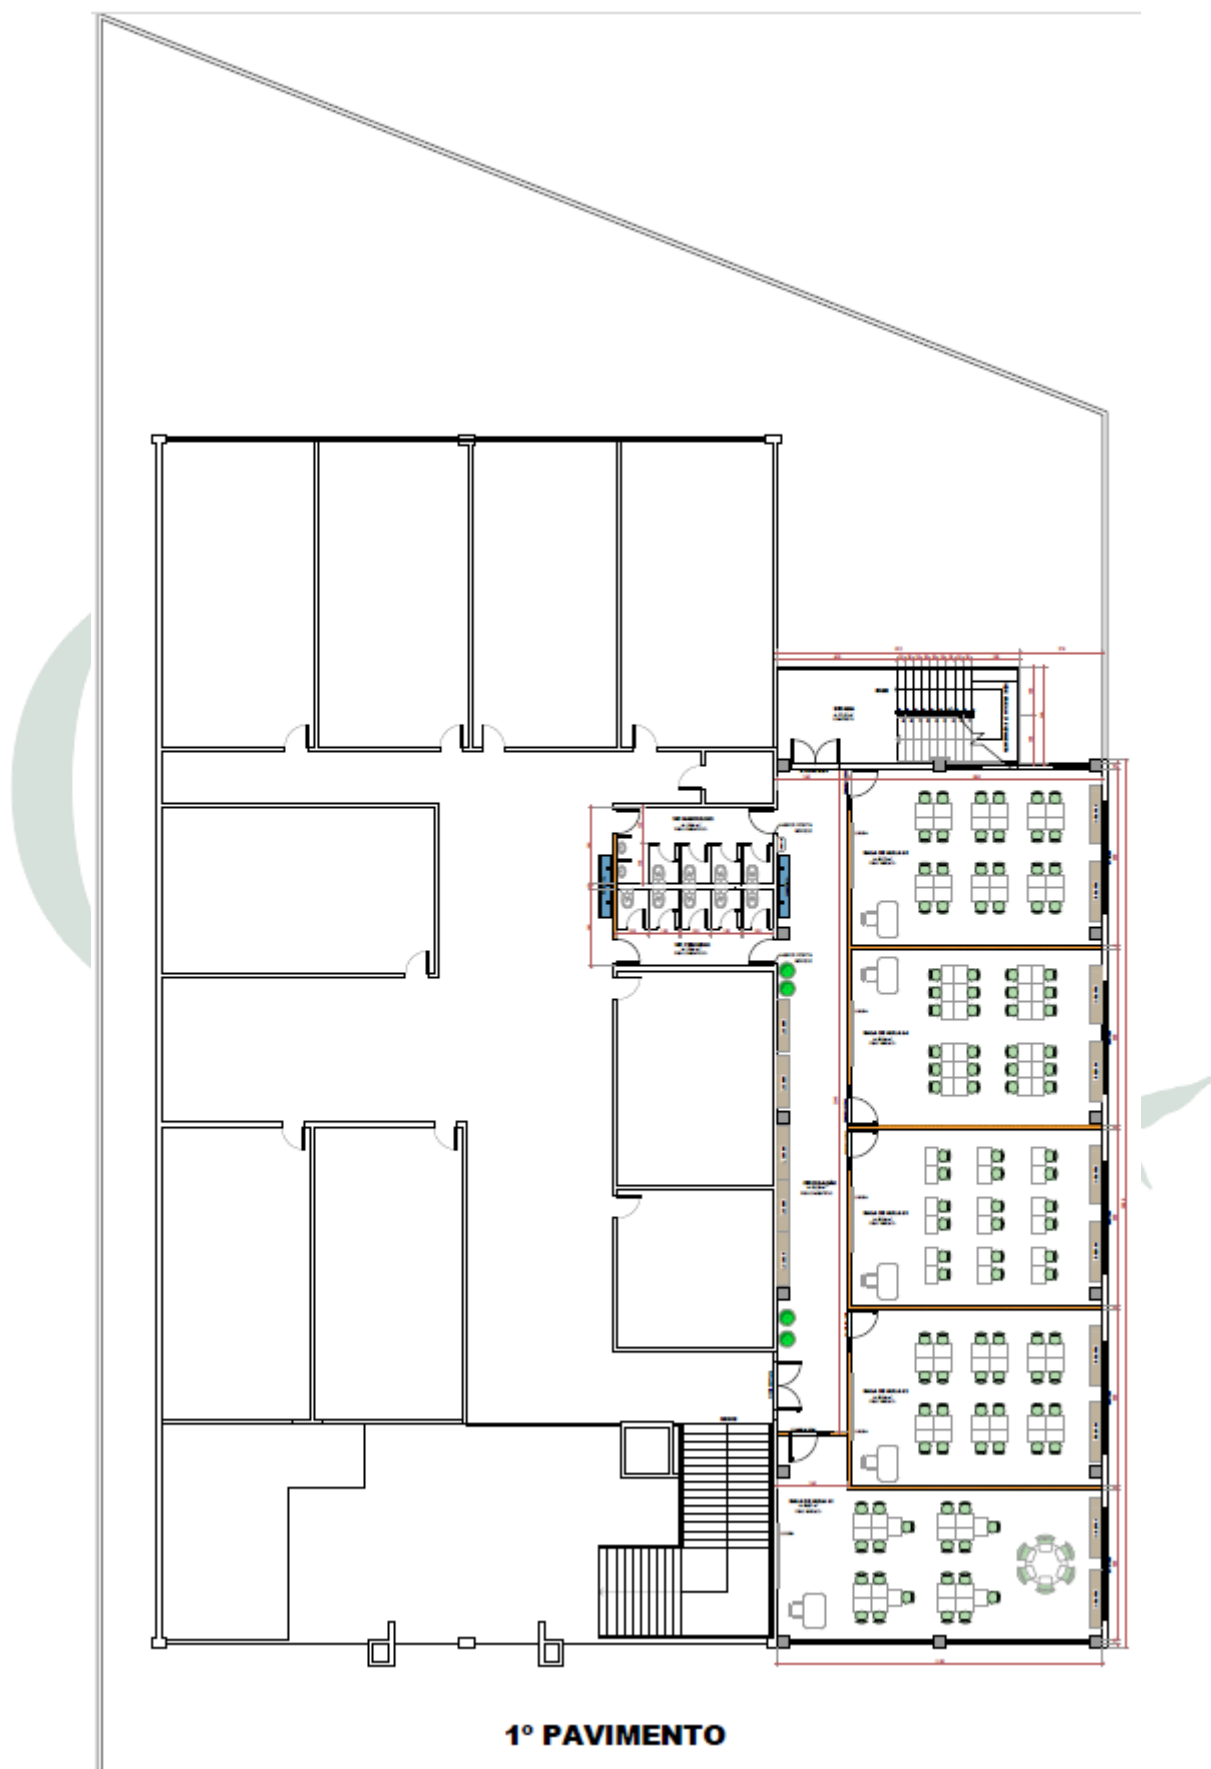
Planta baixa da área existente e a ampliar do 1º Pavimento da edificação.
